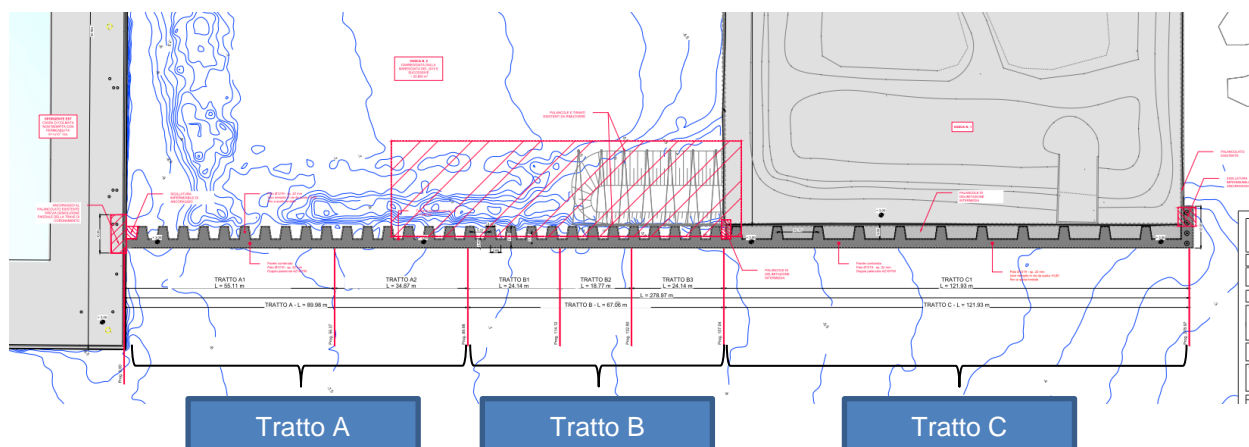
Planimetria generale di progetto (stralcio elaborato MI061P-PDDS4021)
